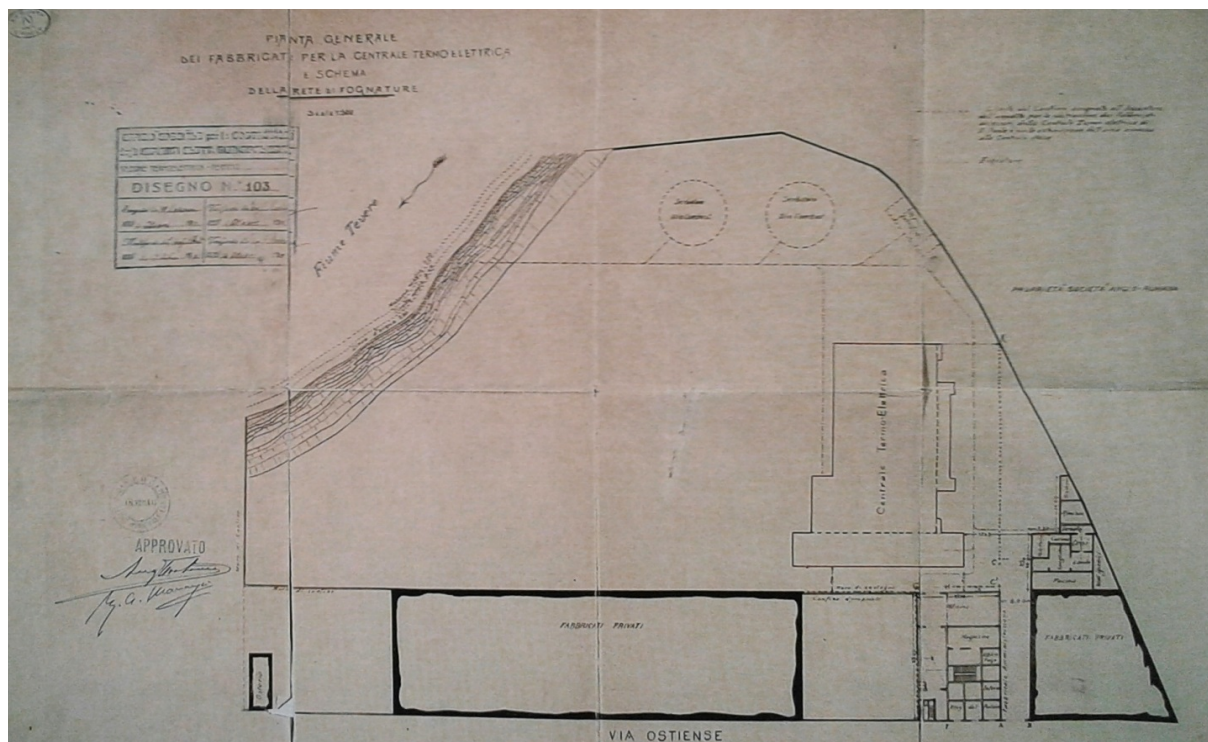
Planimetria del progetto definitivo del 1911, (Archivio storico ACEA).
